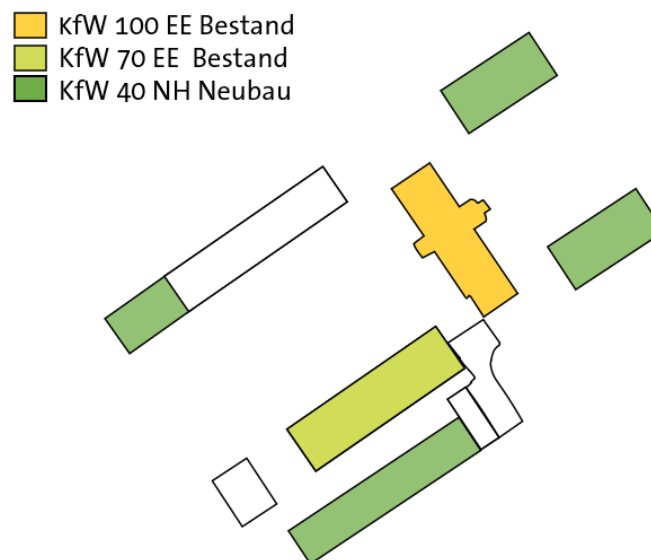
Lageplan und Effizienzhaus-Standards der Gebäude
